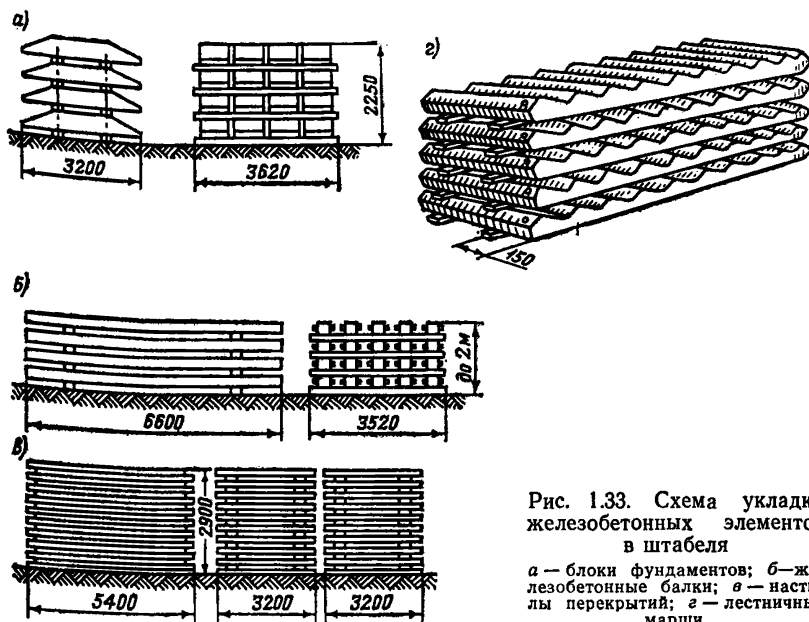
Схема укладки железобетонных элементов в штабеля
